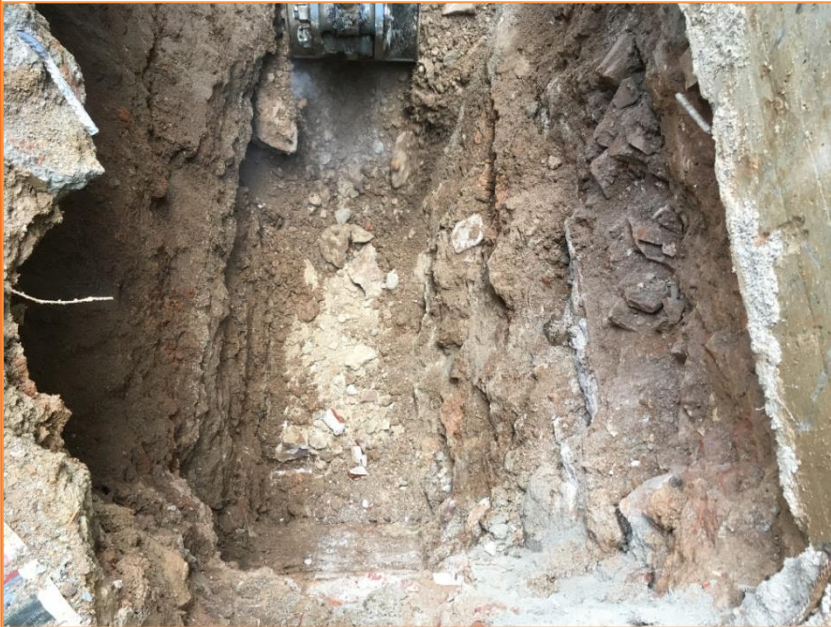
Vista de l'excavació de pantalles, murs UE 36 i UE 38..
